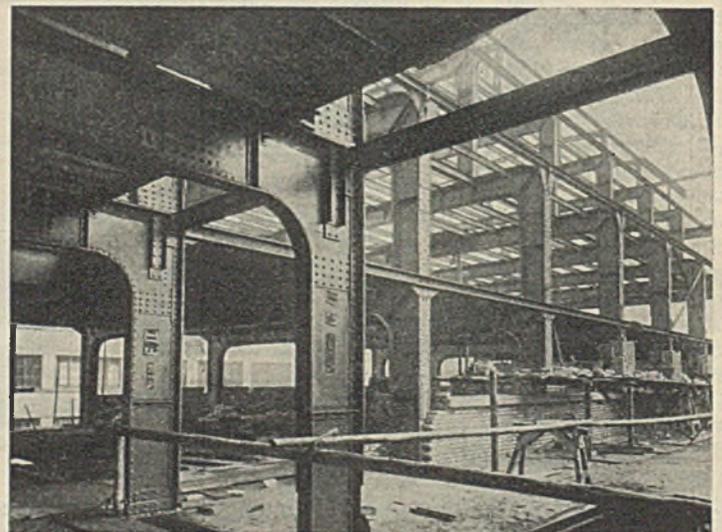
Flügel Kunststraße. Rahmen und Decken im 2. Obergeschoß. Blick nach der Kunststraße zu.
